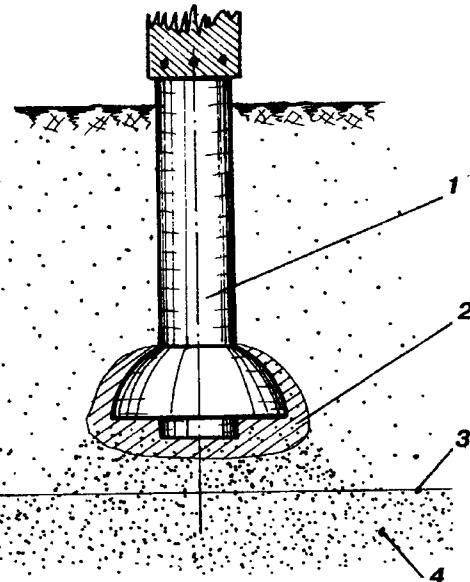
Ореол грунтобетона вокруг опорной части фундаментного столба:
